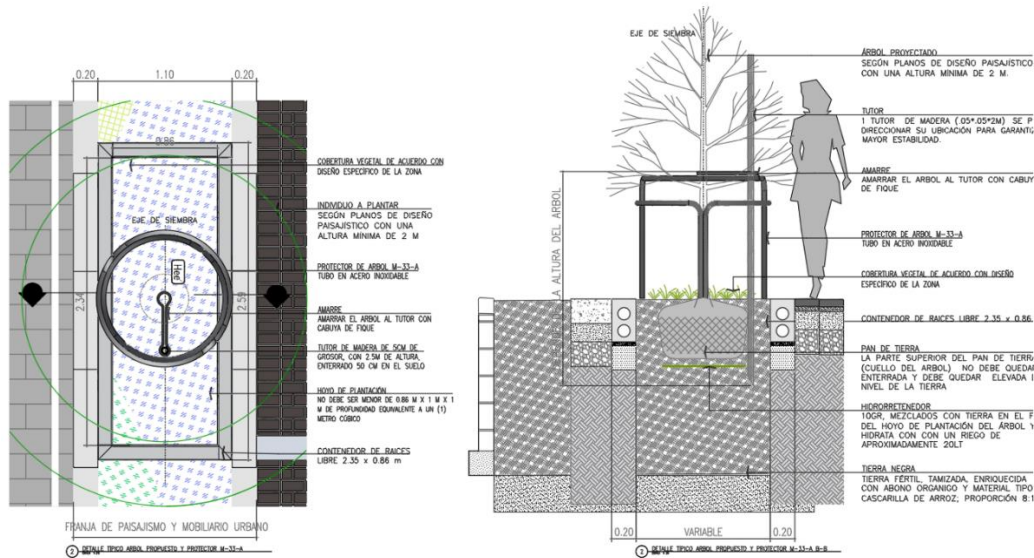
Planta detalle del Contenedor – Alcorque (0.86cm x 2.36)
